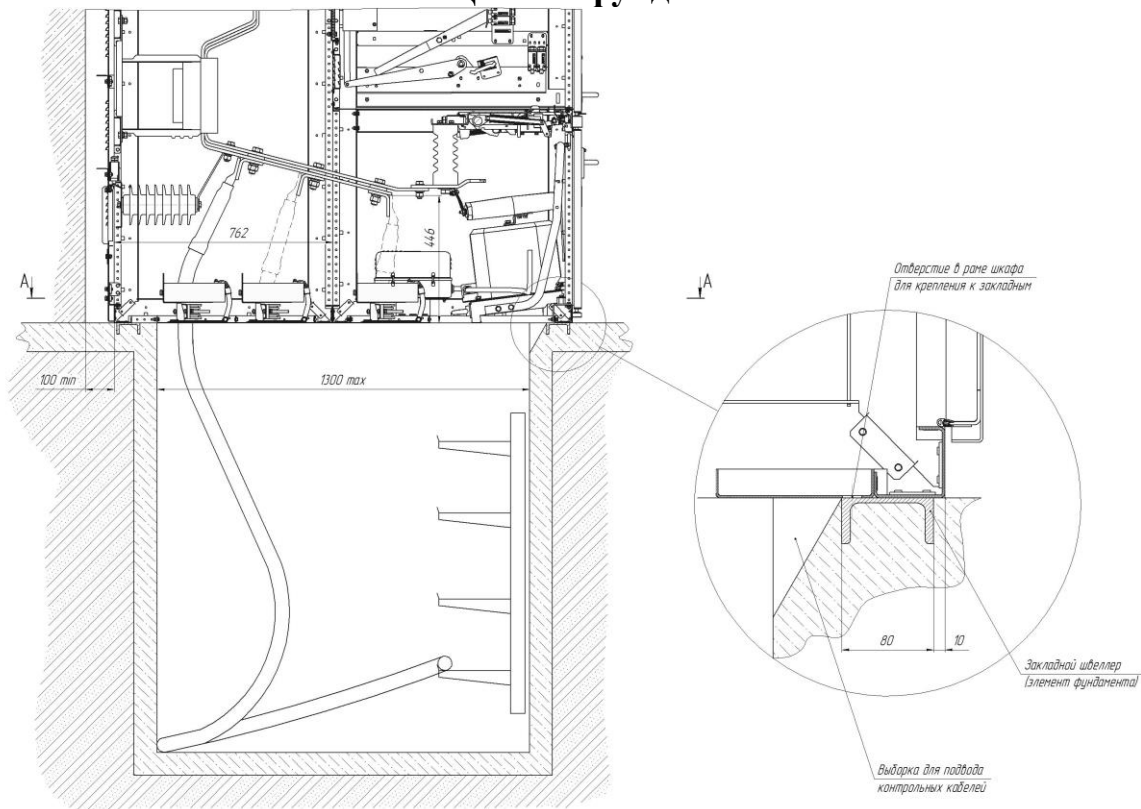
Габаритные размеры шкафов и коридоров обслуживания
